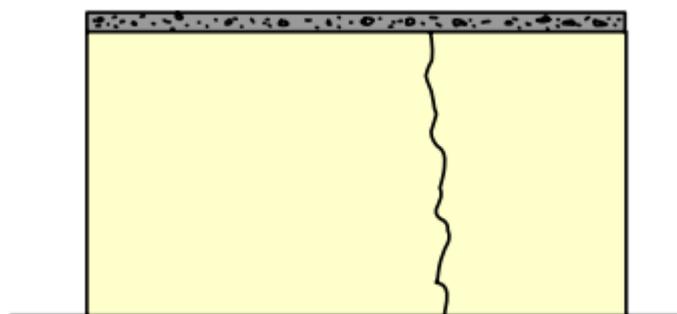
Dilatação dos tijolos por absorção de umidade provocando o fissuramento vertical
